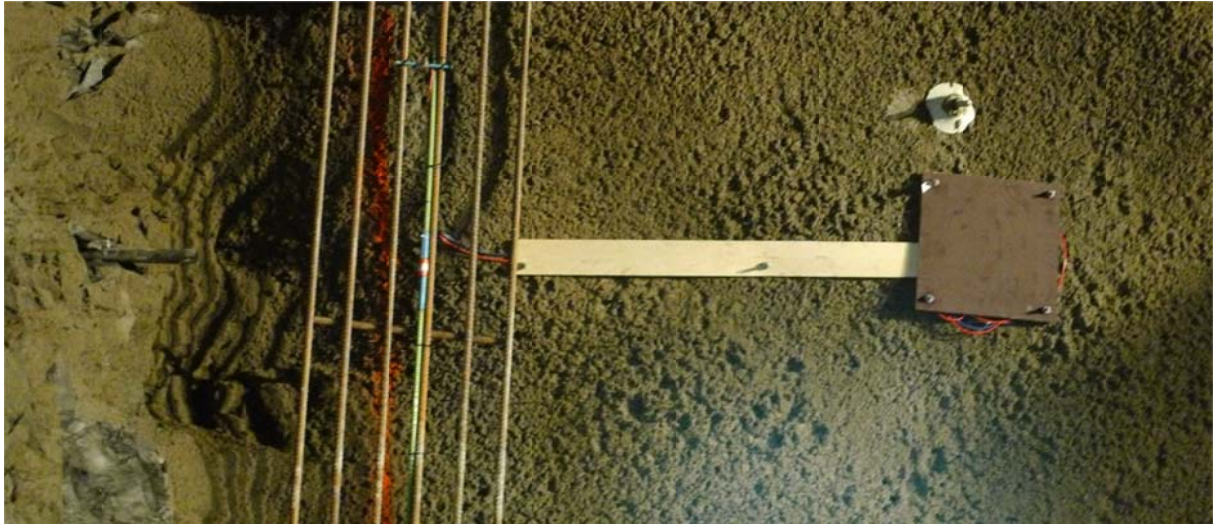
Deformasjonsmålinger i tunnel – ekstensometre fra dagen og instrumenterte buer
